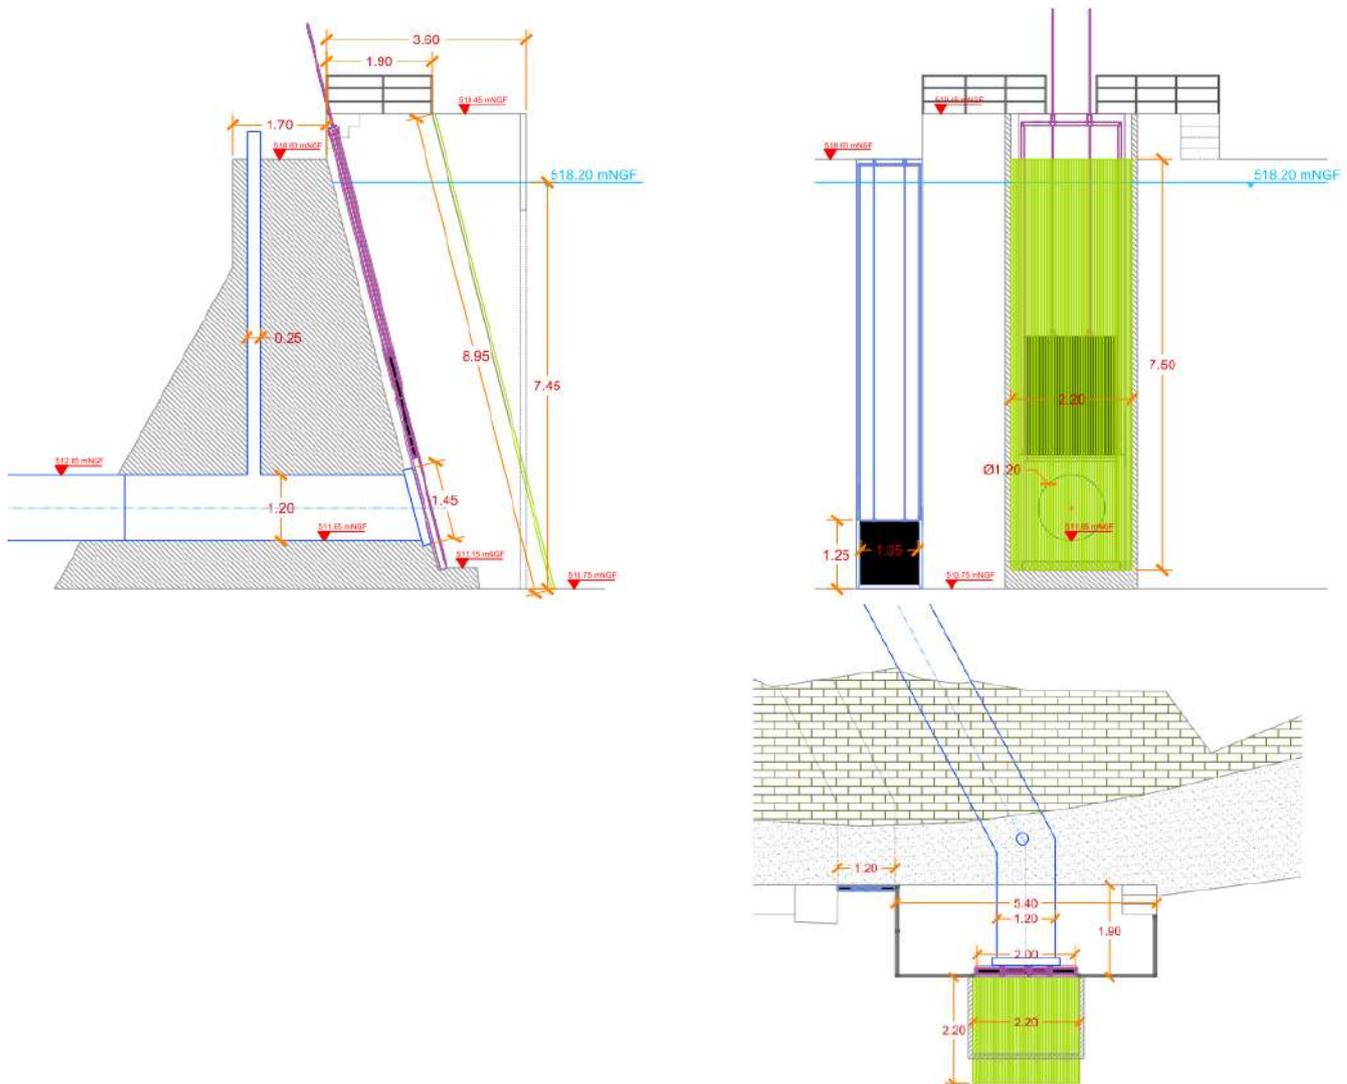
Coupe et plan de la prise d'eau de l'aménagement de Juralina
